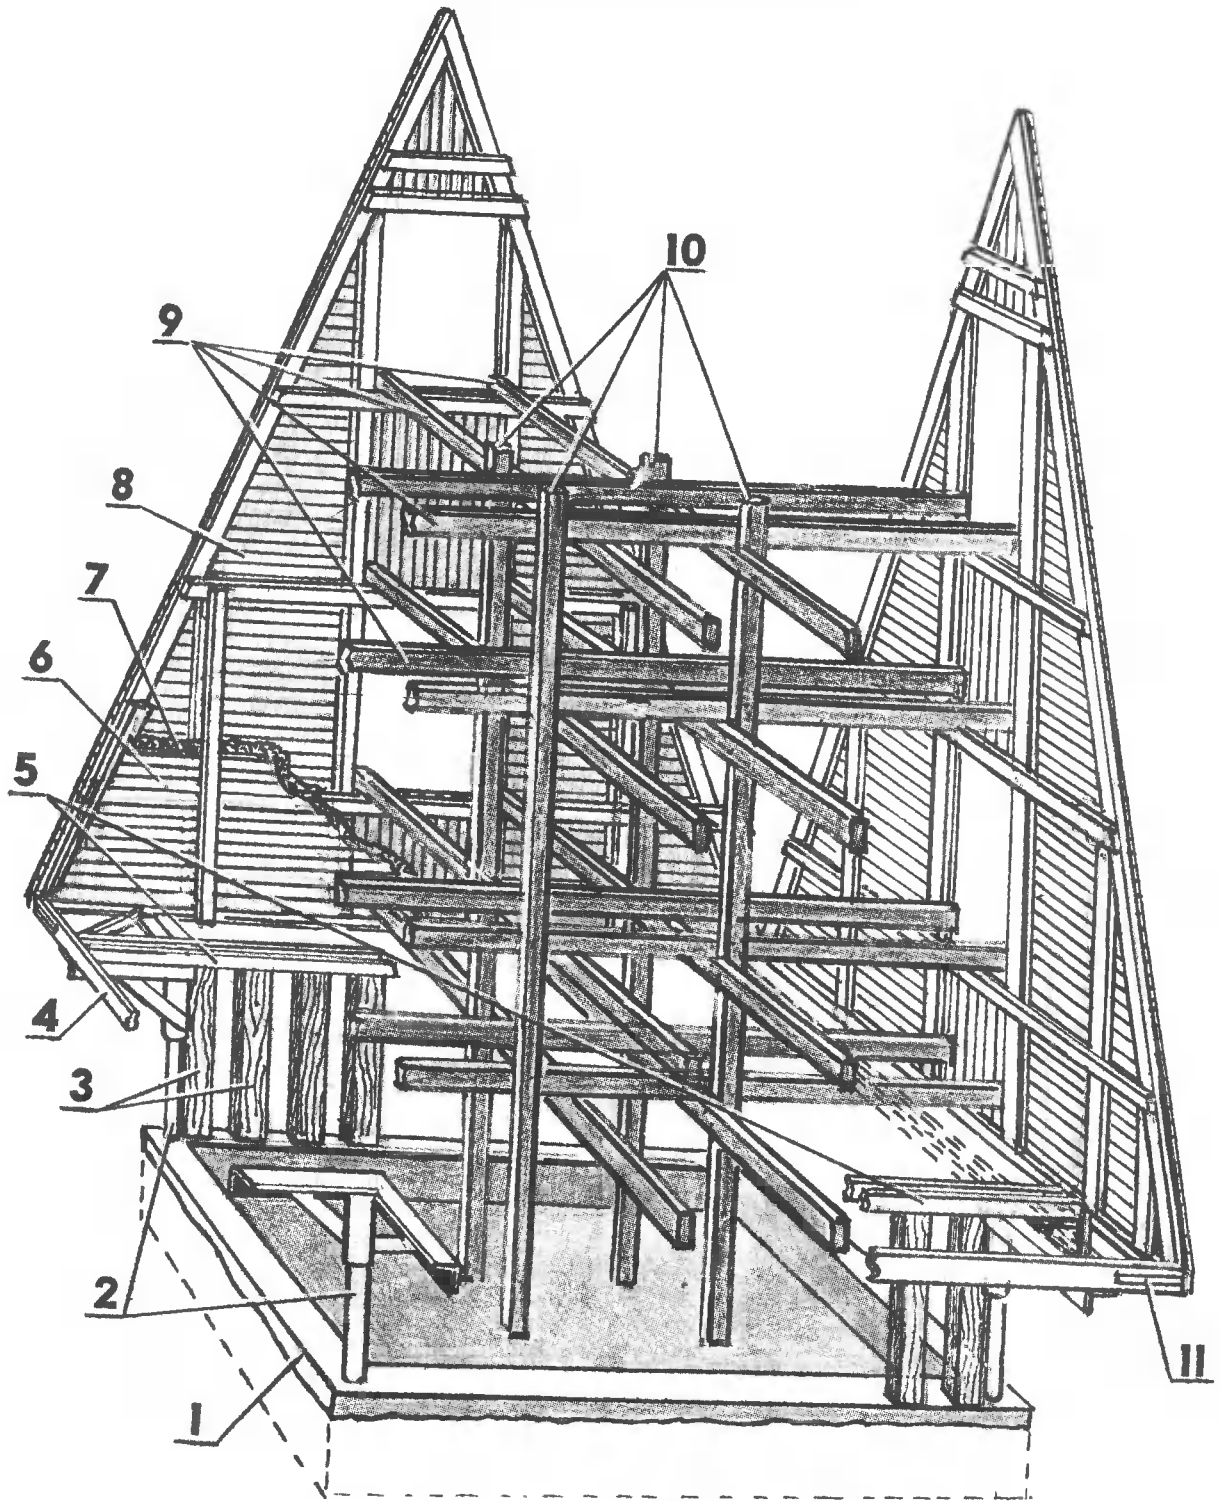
Установка вертикальных строек фронтонов: 1 — фундамент, 2 — опоры с консолями, 3 — шпалы, как подпорная стена дома, 4 — нижняя обвязка, 5 — крепление верха шпал, 6 — внутренняя обшивка, 7 — опилкобетон, 8 — наружная обшивка, 9 — горизонтальные элементы лесов, 10 — вертикальные элементы лесов, 11 — металлическая полоса.
